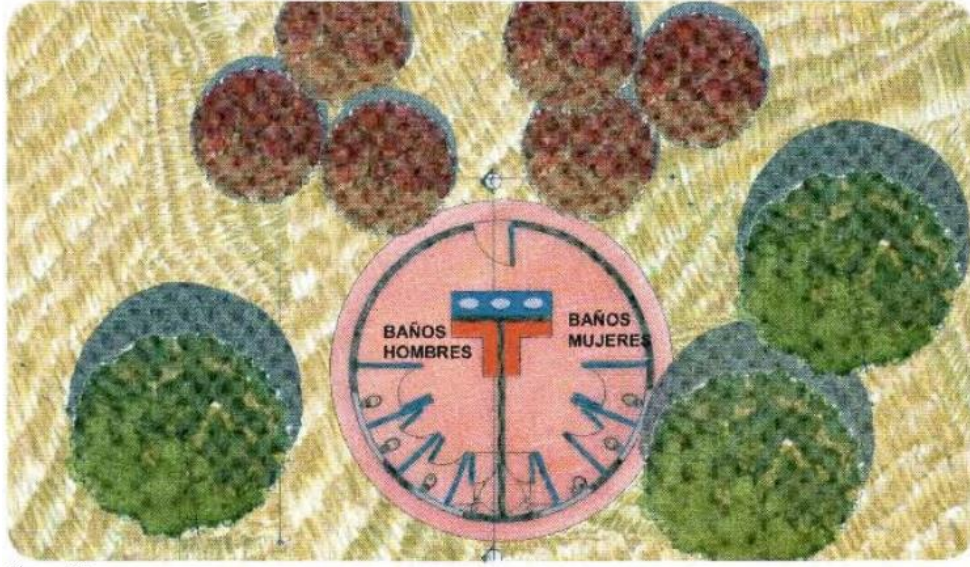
Planta arquitectónica para un módulo de baños. Fuente (SECTUR, 2005) página 83.
